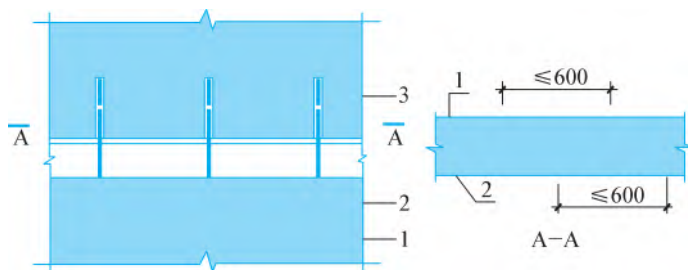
预制剪力墙竖向分布钢筋连接构造示意
